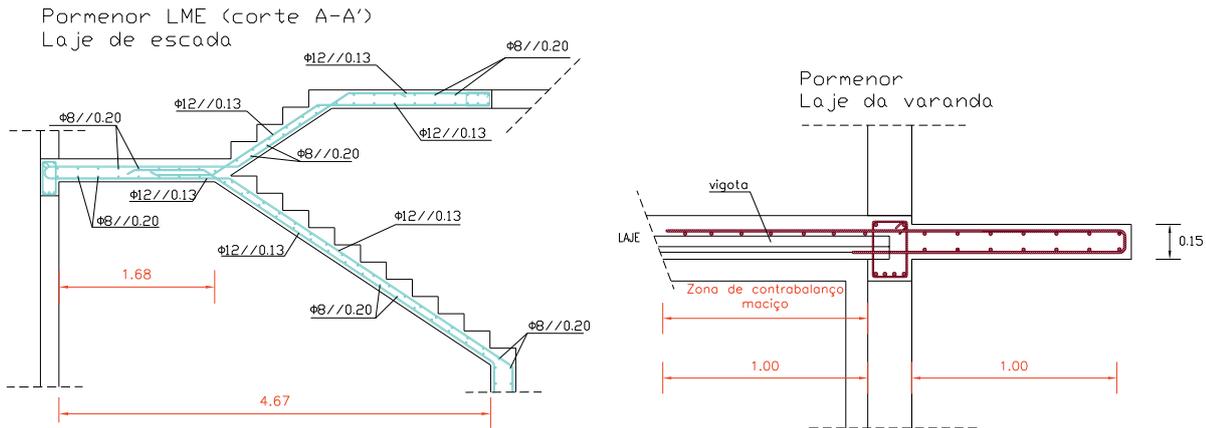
Pormenores de lajes de escada e varanda em BA
